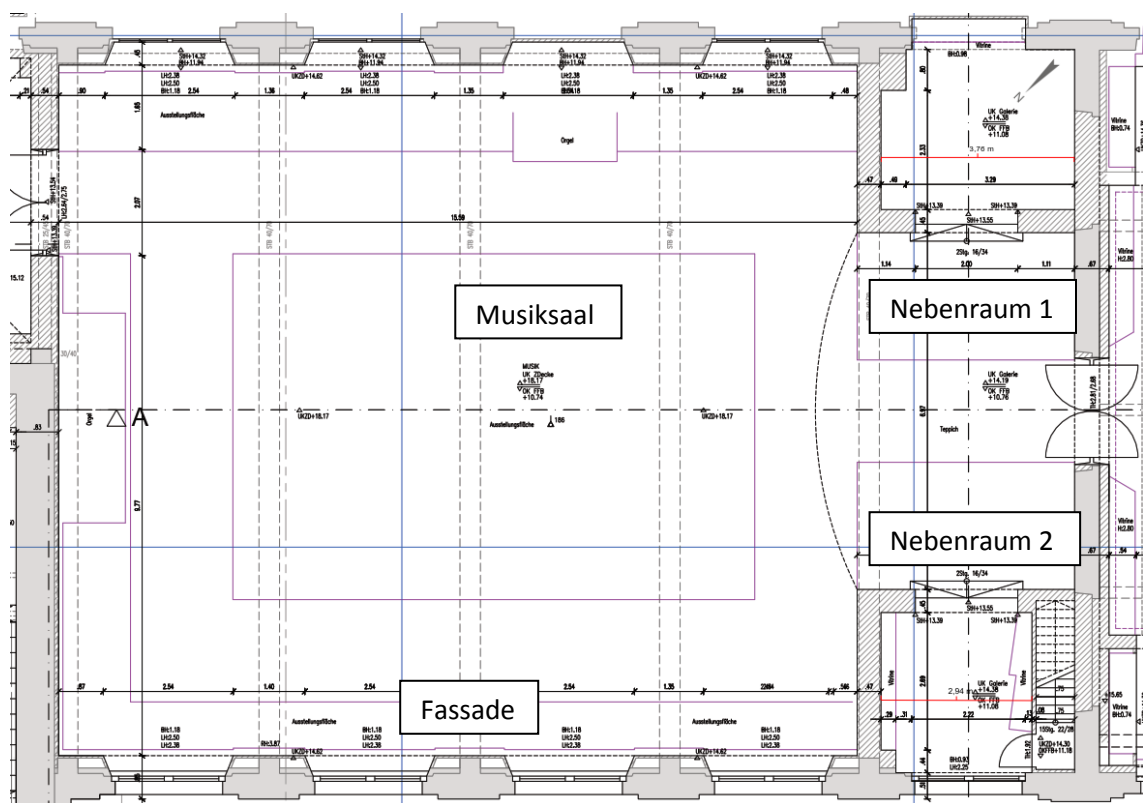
Grundriss des Musiksaales im Bestand mit den Nebenräumen 1 & 2
